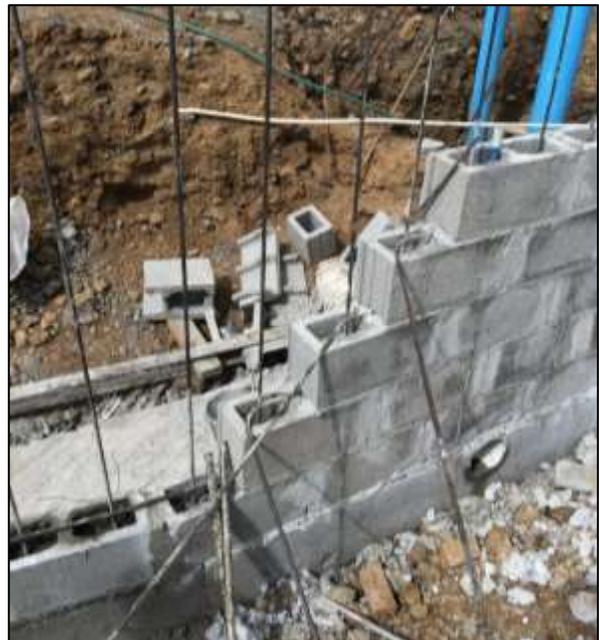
Varillas longitudinales dobladas en muro de mampostería, pierden capacidad al ser enderezadas de nuevo.
